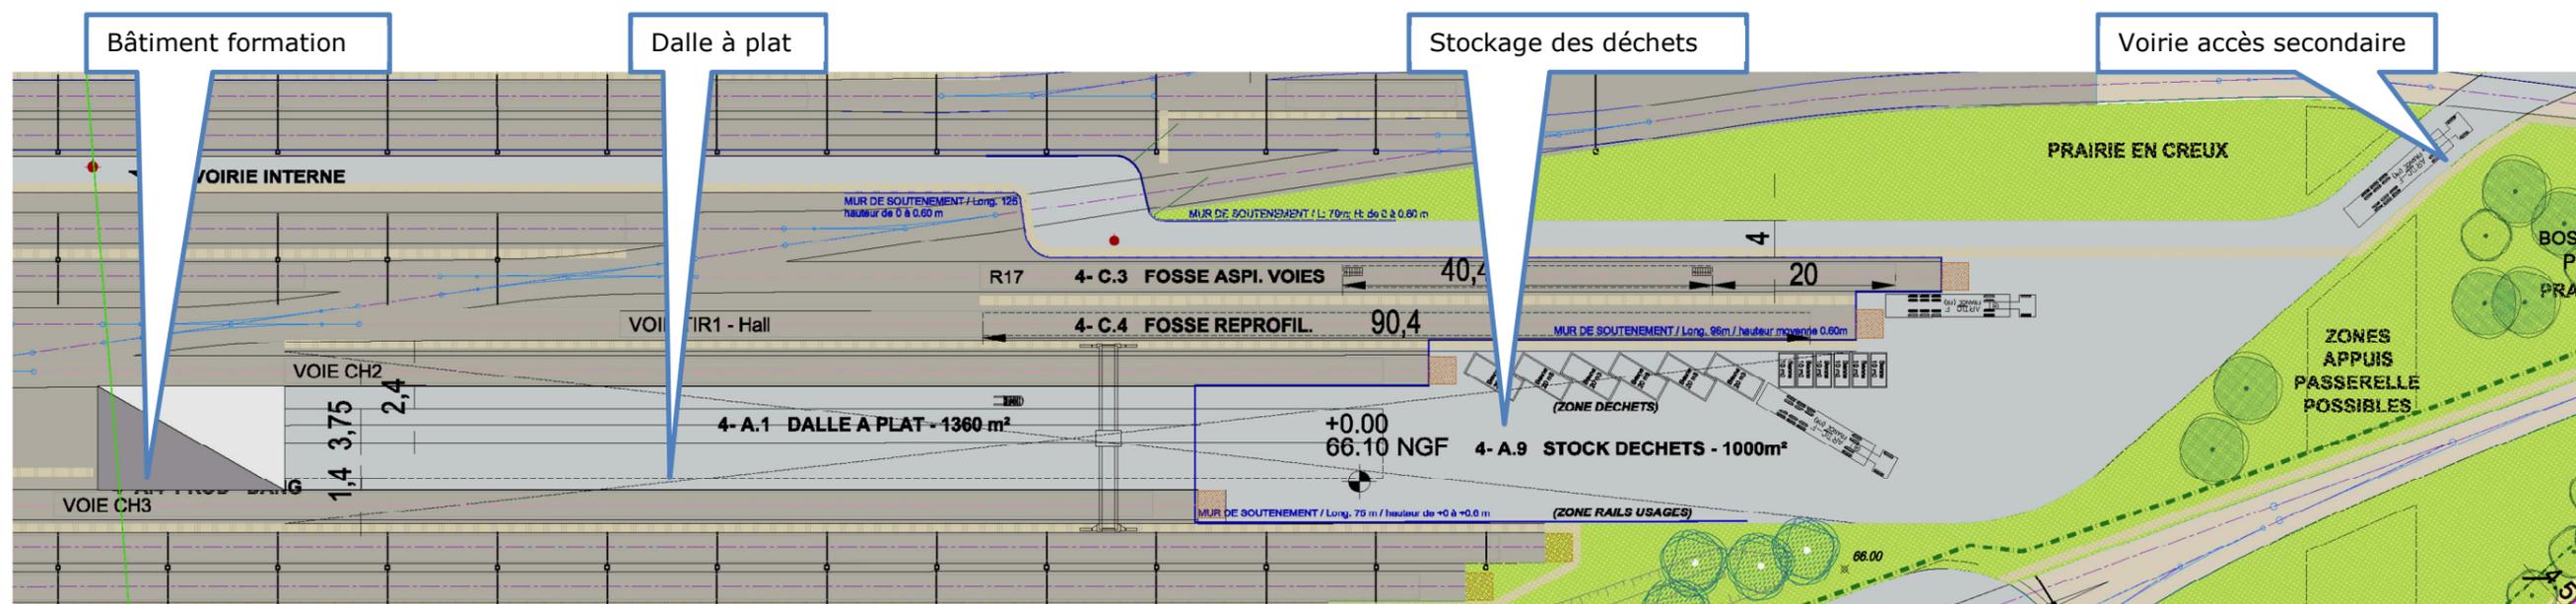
Le secteur de la dalle à plat, extrait du plan masse
